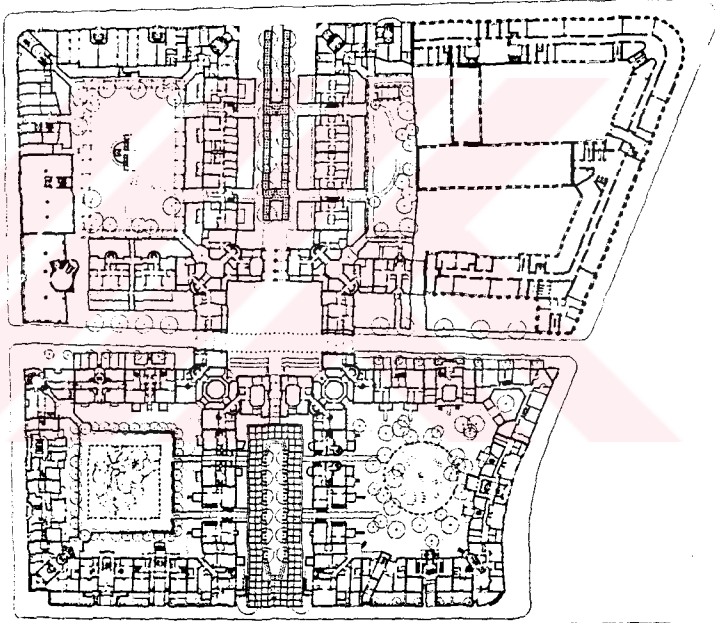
Rob Krier'in Schinkelplatz planı
